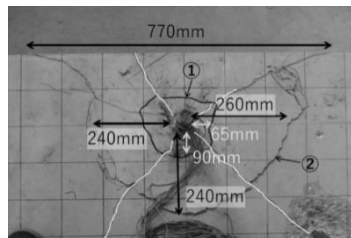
コンクリート表面のひび割れ (Case-1)
